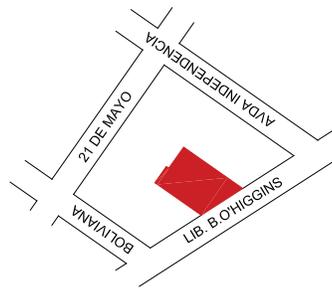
PLANTA UBICACIÓN MERCADO ANTIGUO.
